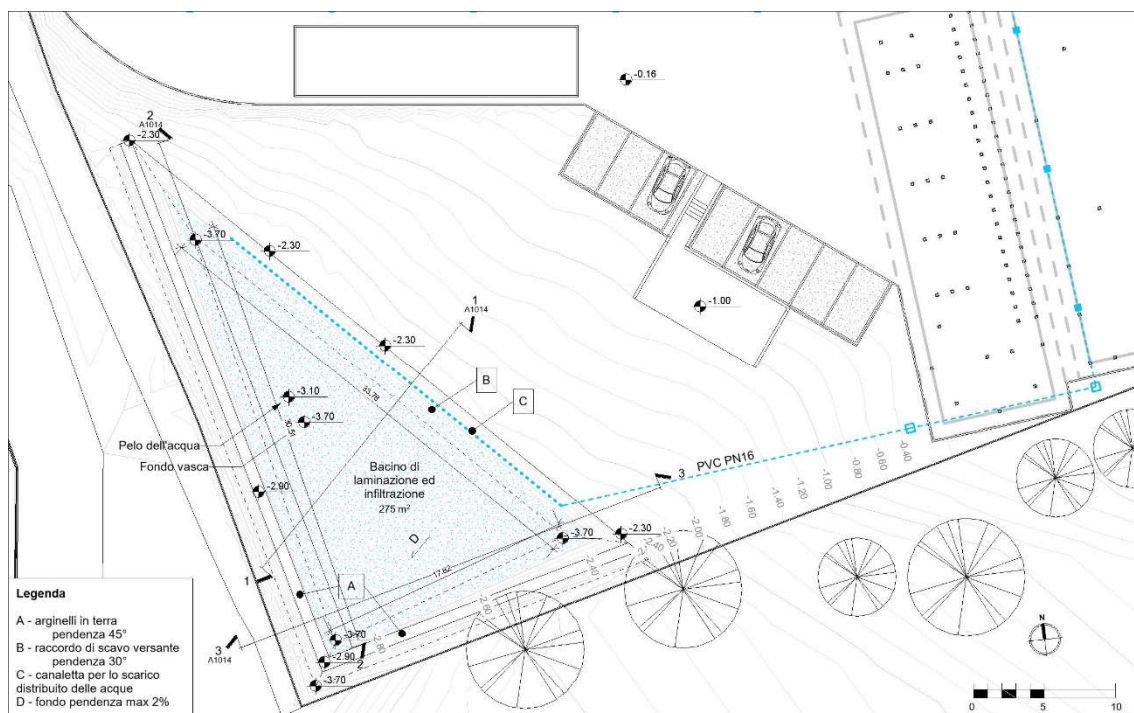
Planimetria raffigurante il bacino di laminazione e infiltrazione – Fuori scala
